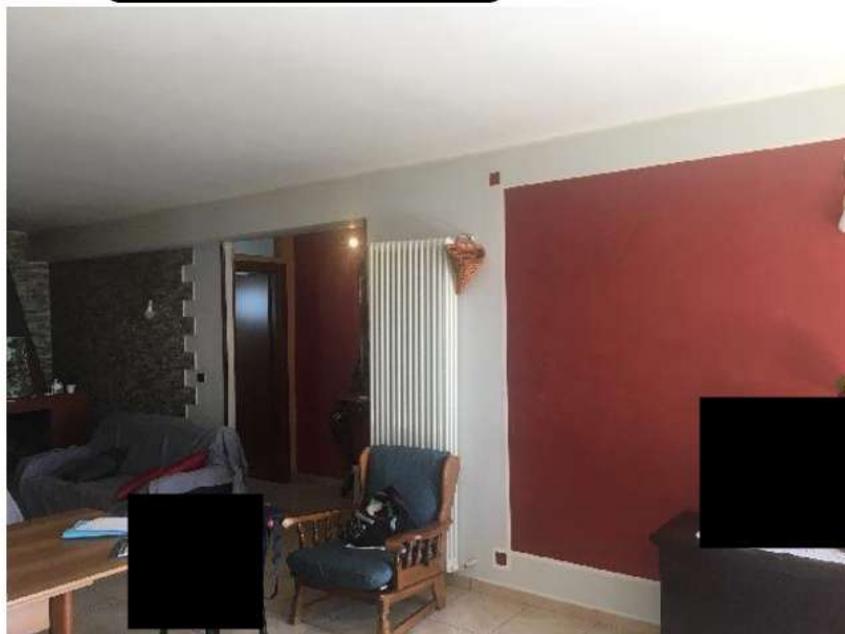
INGRESSO TAVERNA SEMINT.
